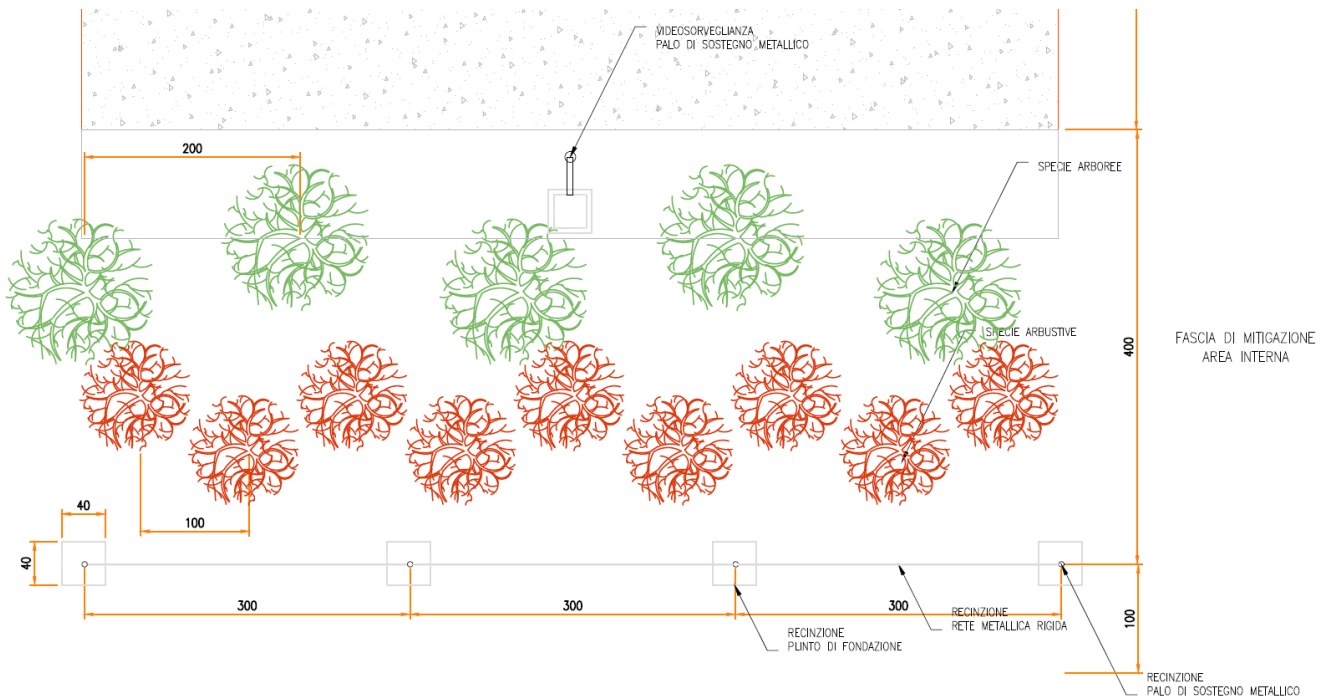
Particolare vista in pianta possibile soluzione di mitigazione
